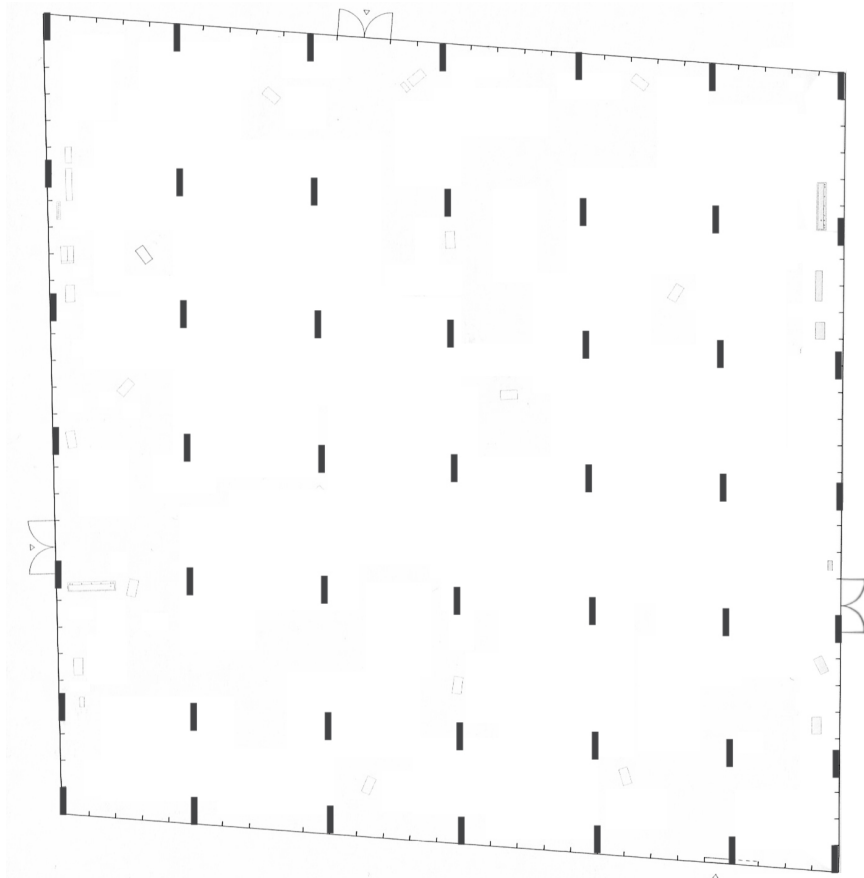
Planta ficticia del KAIT con 120 pilares trabajando a compresión.
